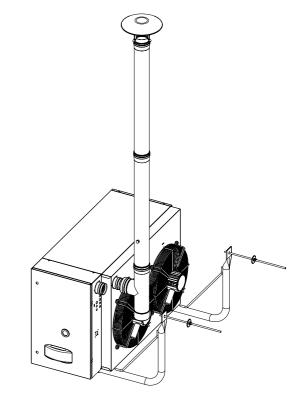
Installazione tipo B23 con tubo fumi a tetto Ø 80
